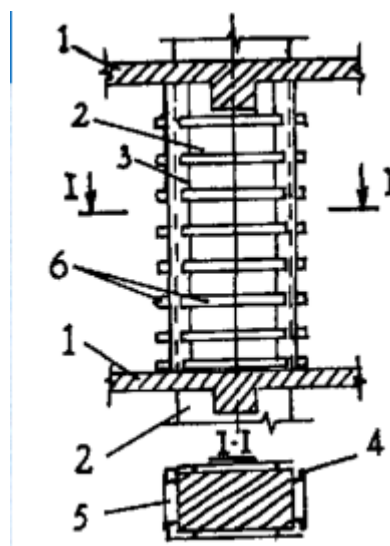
Усиление колонны металлической обоймой: 1 - перекрытие; 2 - усиливаемая колонна; 3 - обойма; 4 - уголки-стойки; 5 - поперечные планки; 6 - опорные планки
